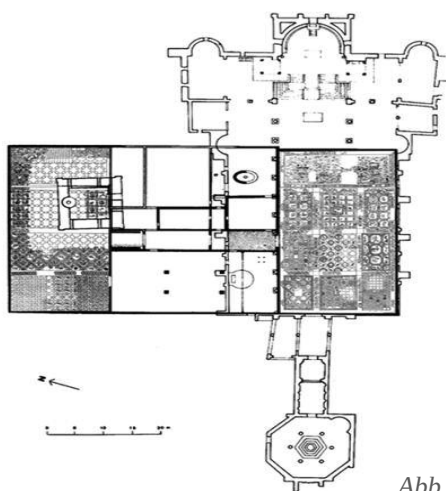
u. 206: Aquileia I, Grundriss und Rekonstruktion
